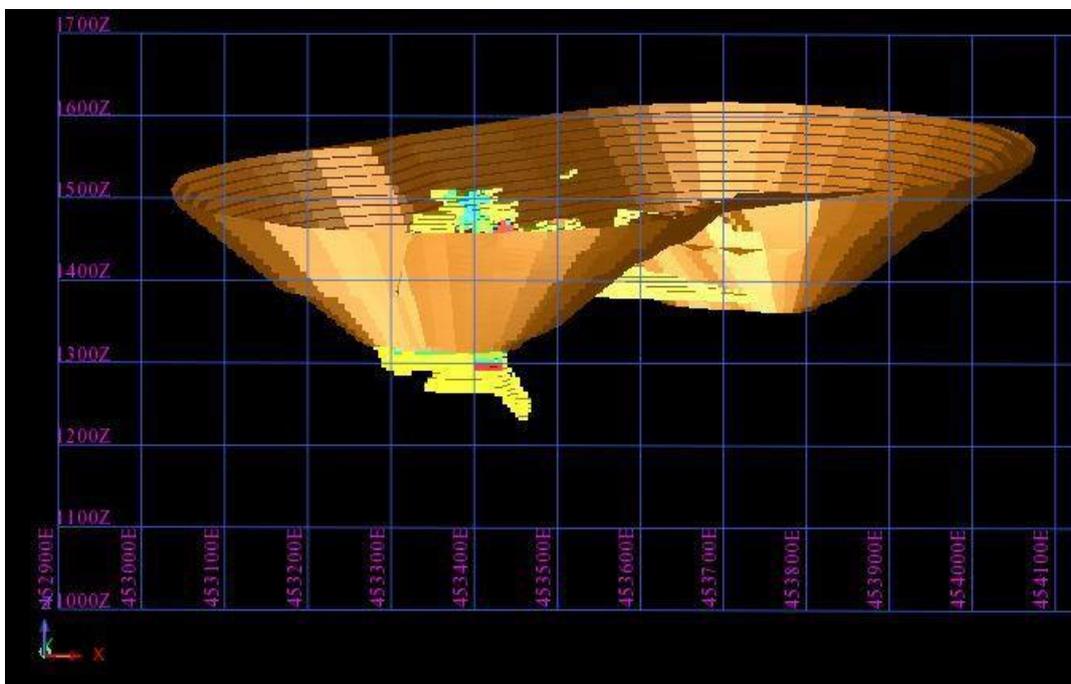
Plan de la Borne XIII et Extension de la mine jusqu'à 1245m (plan ZX)
